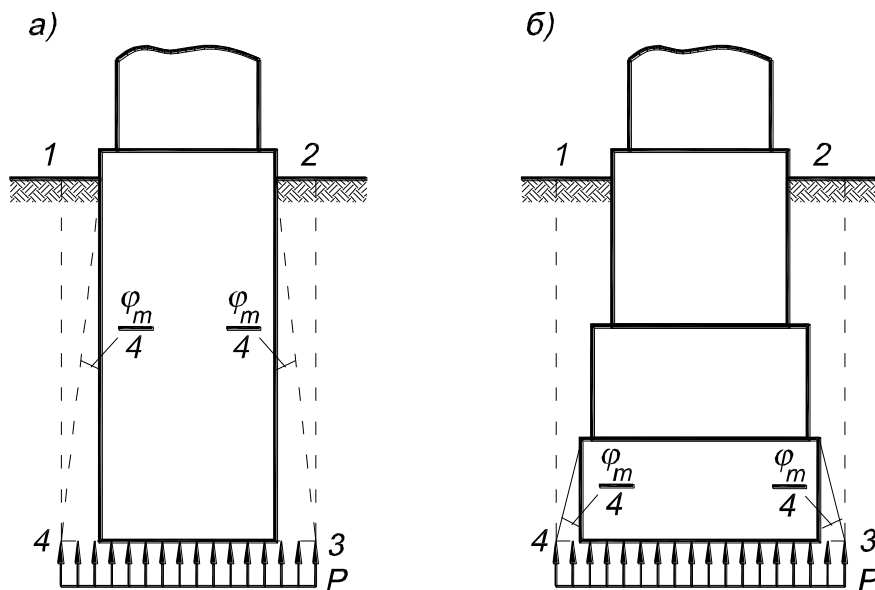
Умовний пальовий фундамент з ростверком, заглибленим в ґрунті при куті нахилу паль, більше ніж  $\varphi_m / 4$
